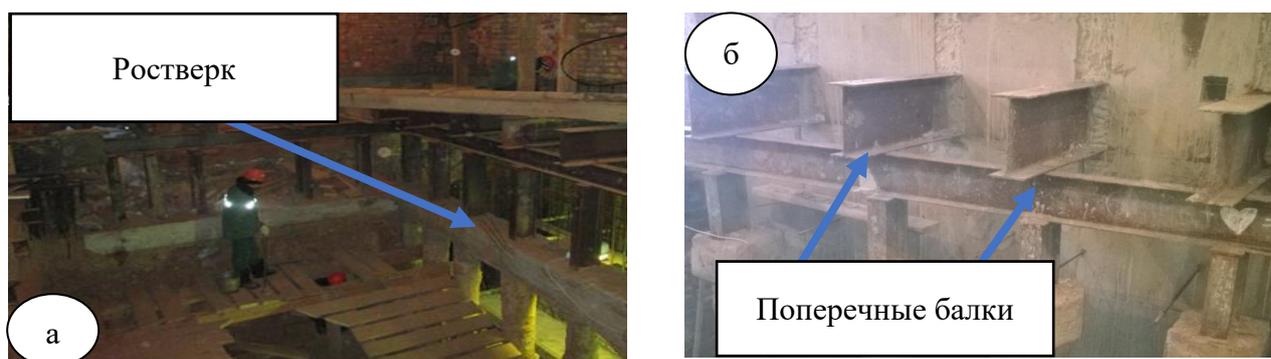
а) устройство ростверков; б) устройство поперечных балок
